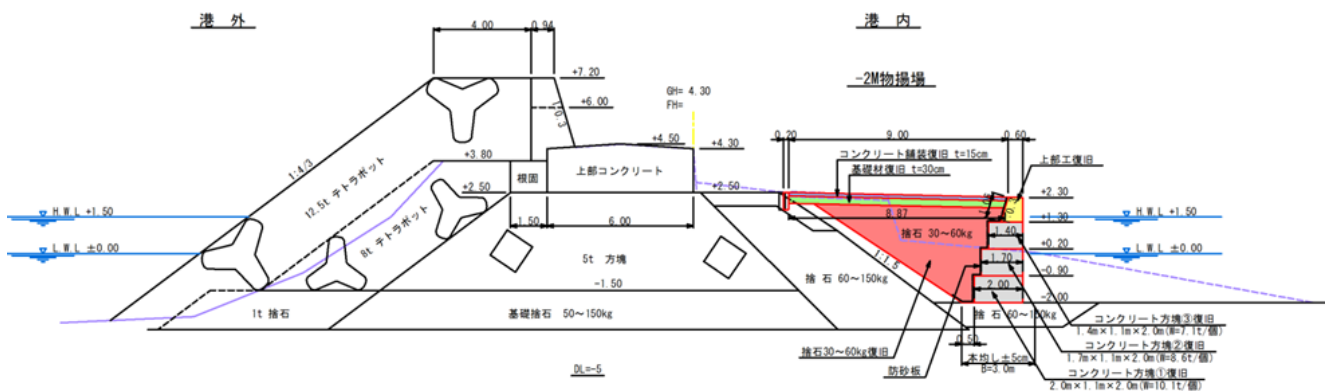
264 No.25 大洗港区\_第1埠頭地区B物揚場 (-2m) の断面図 (復旧後)
